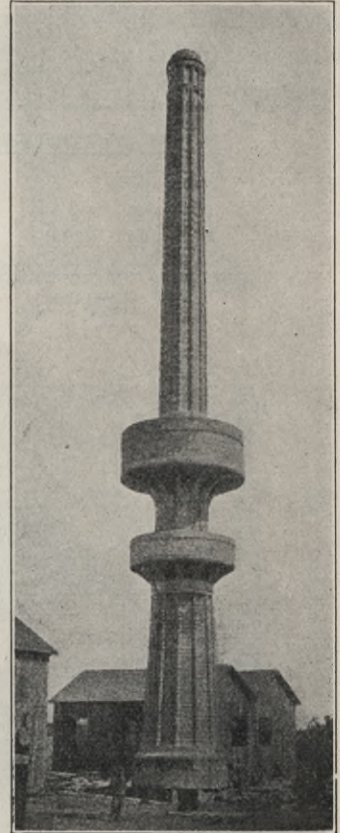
Eisenbeton-Schornsteinbehälter in d'Anderney-Chevillon.
